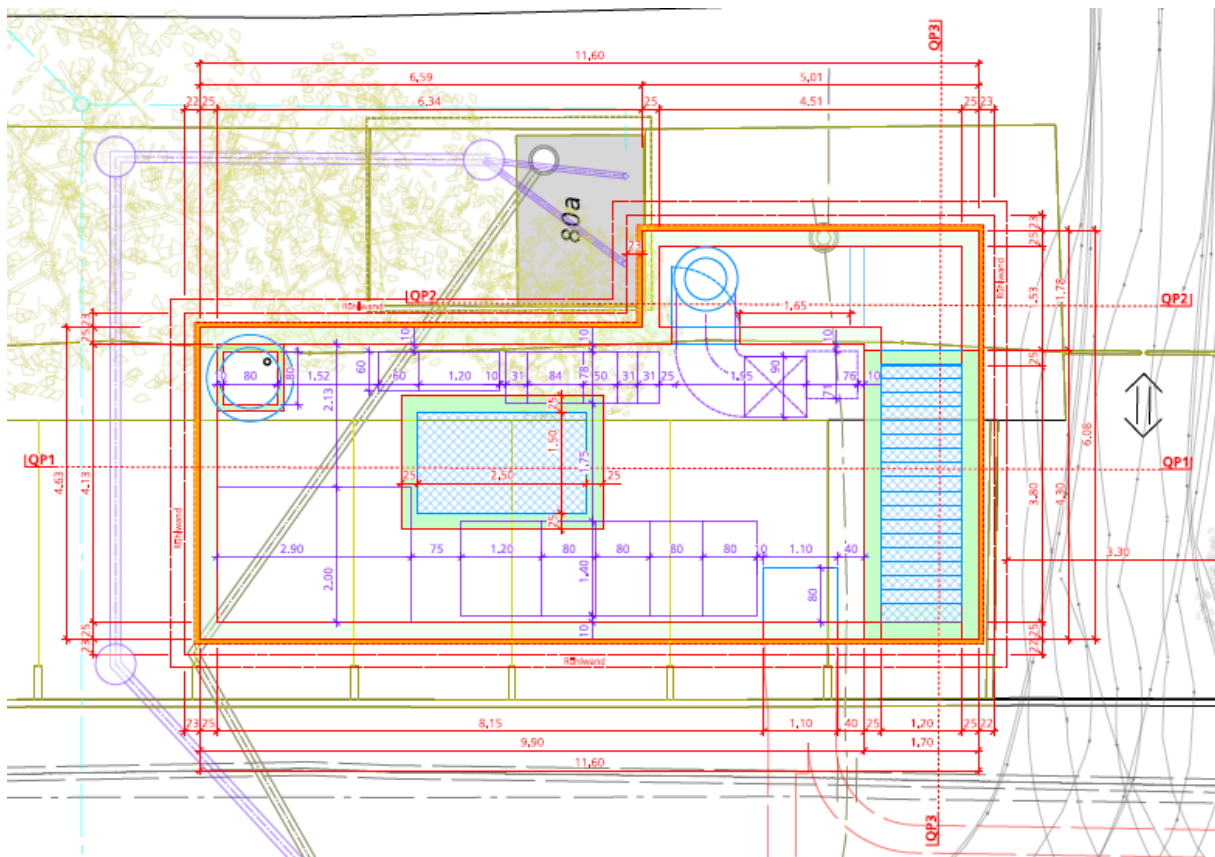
Grundriss Gleichrichteranlage Somazzistrasse
